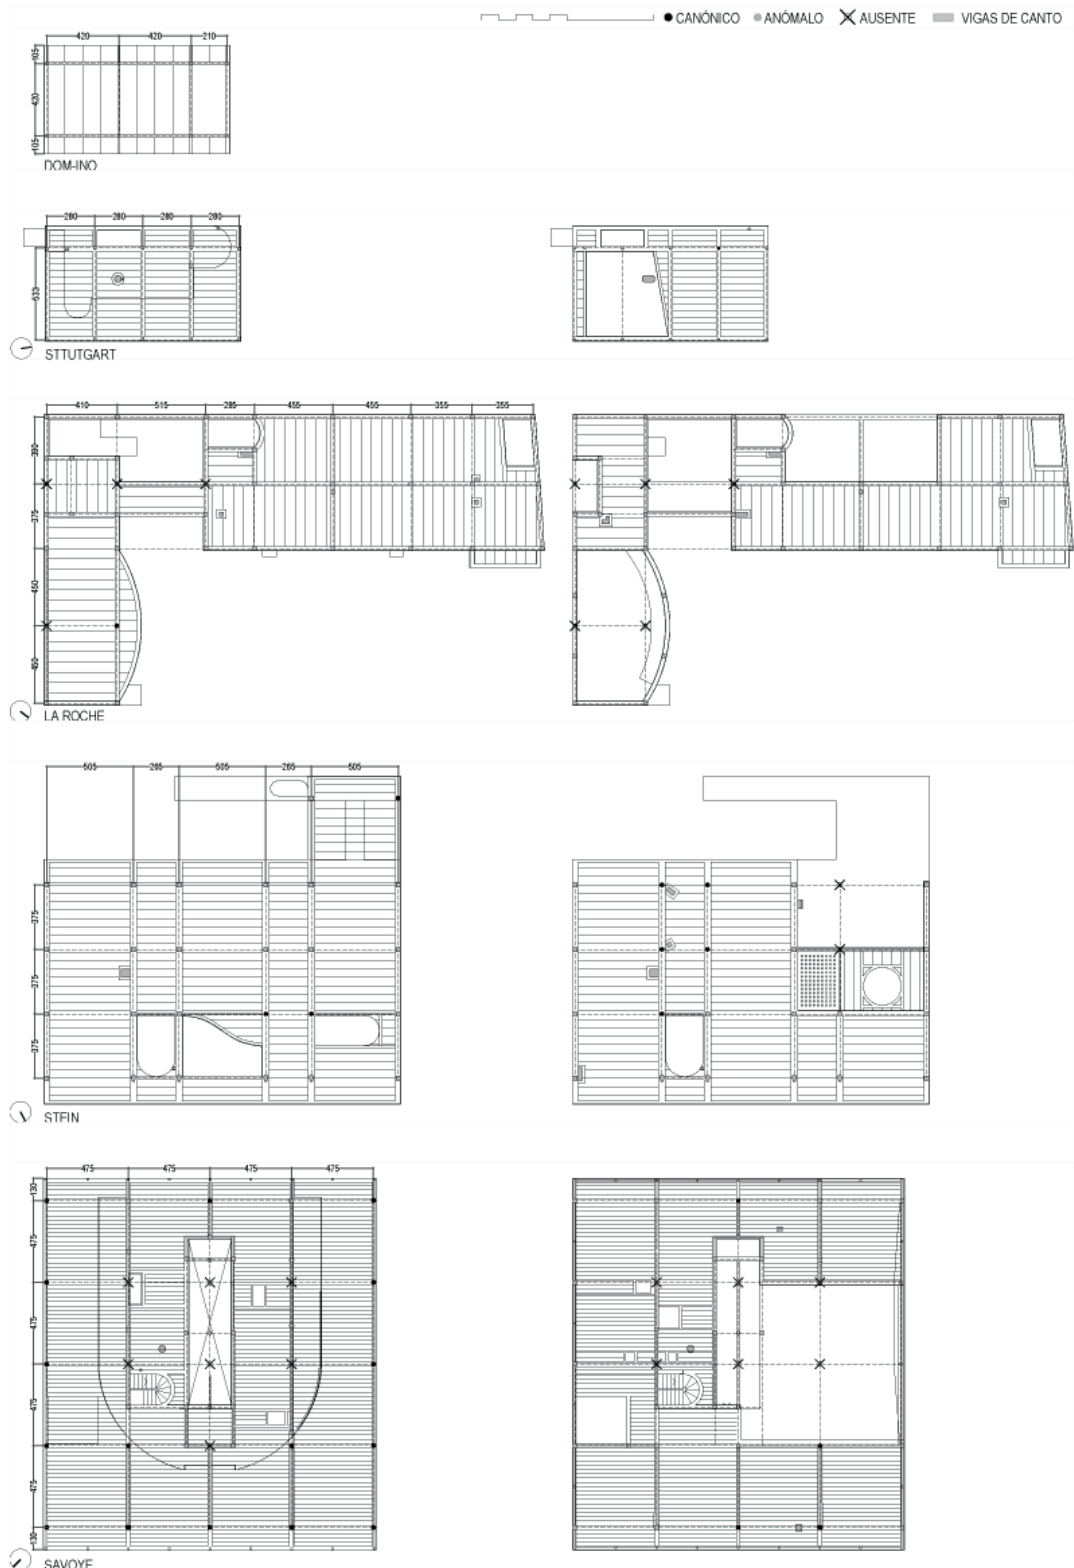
Esquemas de la estructura de techo de planta baja y primera de Dom-ino, La Roche, Stuttgart, Stein y Savoye. Elaboración propia.
